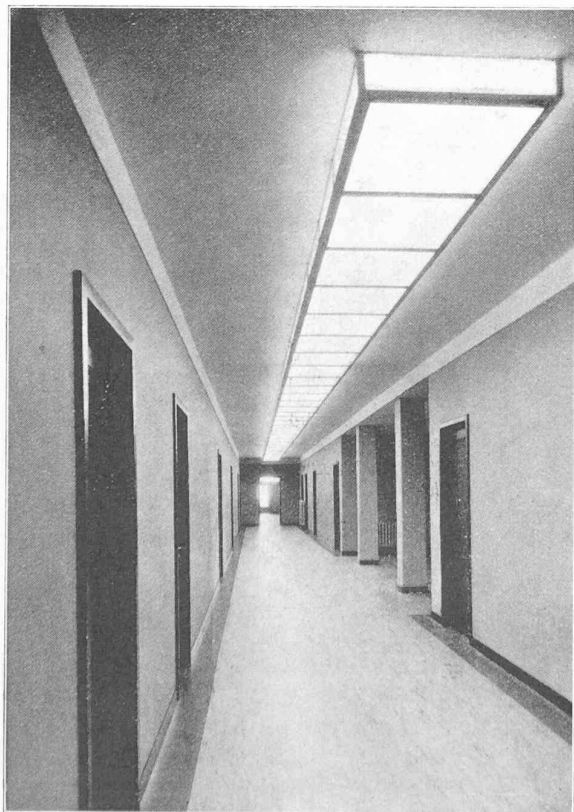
Eclairage d'un couloir par caissons lumineux.
